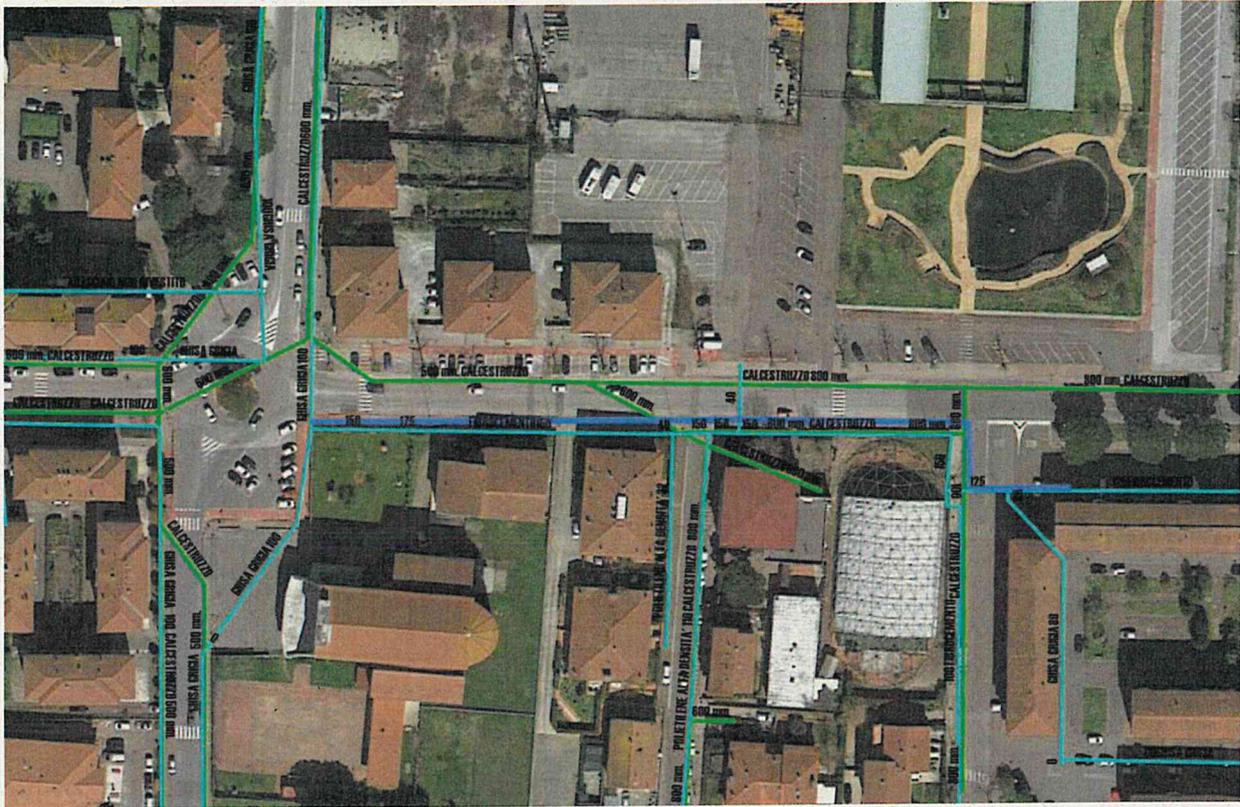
Planimetria tracciato (blu) e rete esistente (celeste/verde) su base CTR
